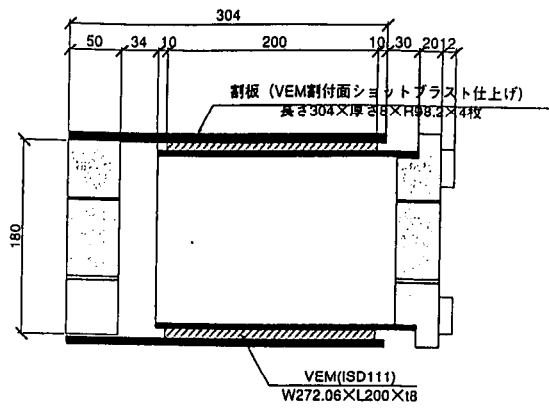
粘弾性体部_断面図 1/5 (1038cm²)
